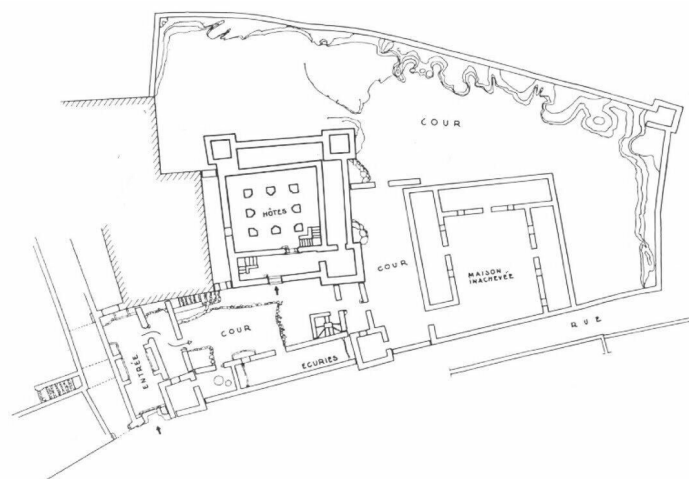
План первого этажа «Kasbah Ait Ouarrab».
